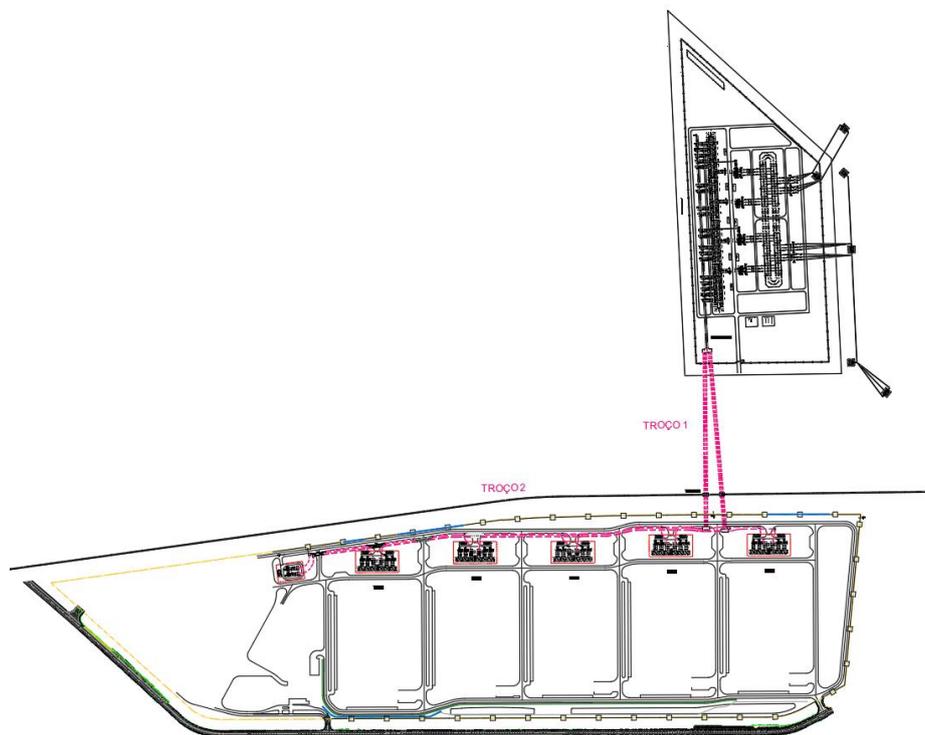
Esquema geral do traçado entre a subestação de 400 kV e o campus.
